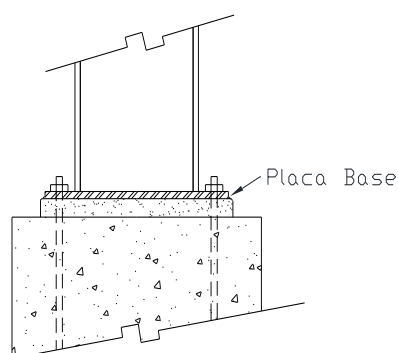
Detalle típico de placa base para la conexión columna fundación.
